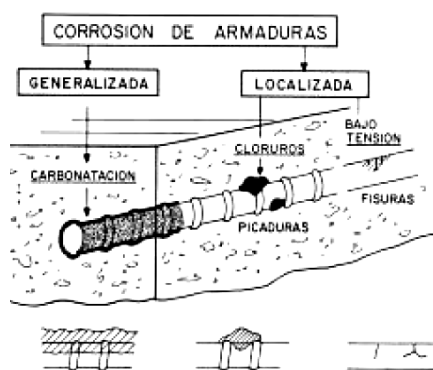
Tipología de la corrosión de la armadura en el hormigón armado (ANDRADE, C., ALONSO, C. SARRIÁ, J. y CASTELLOTE, M. (1998). Conceptos básicos sobre corrosión de armaduras) [8]
